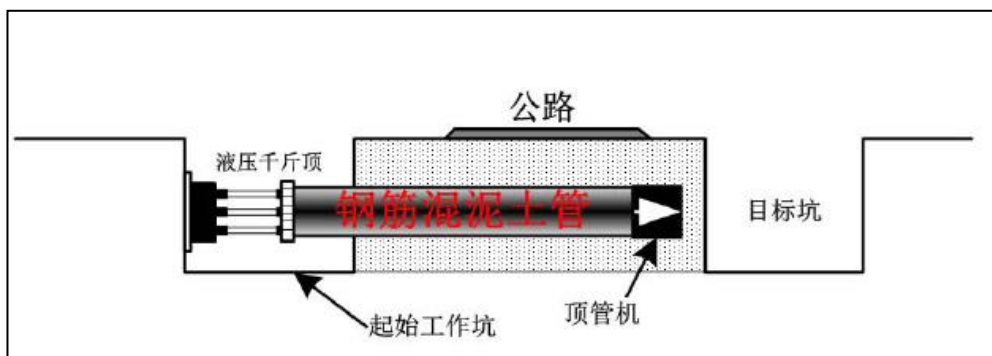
顶管施工工艺穿越公路剖面示意图
